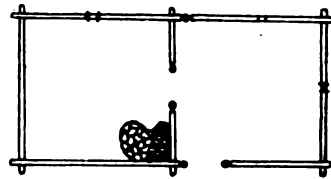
Jassew bei Kobylmit. Grundriß zu Abb. 2.
